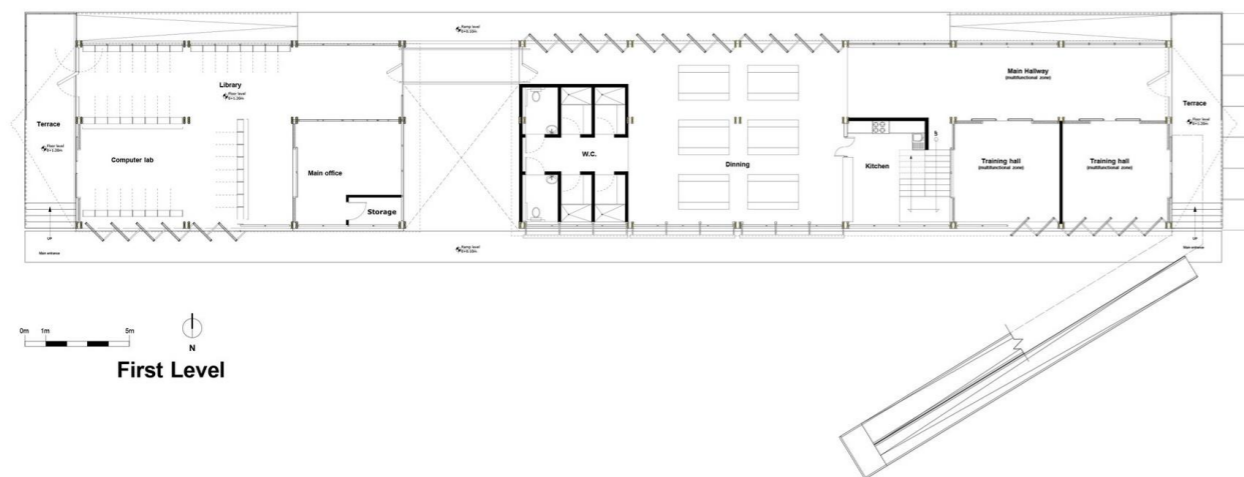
Planta de distribución principal, fuente: Archdaily.com, 2014
